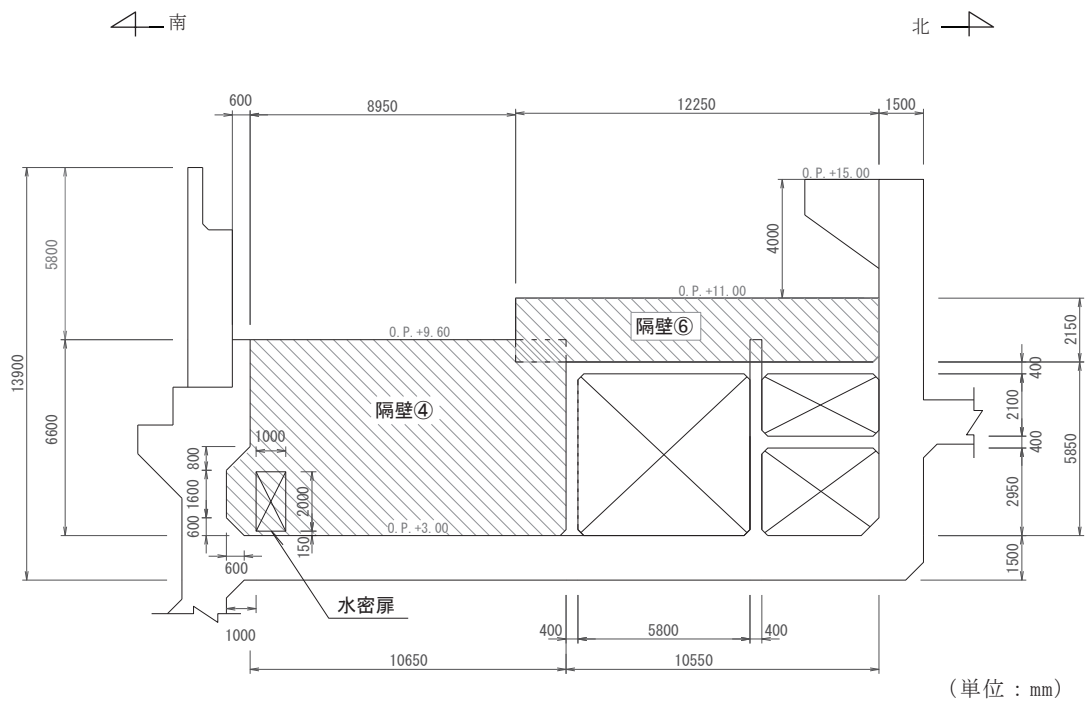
(4) 補機ポンプエリア断面図 (④—④断面)
